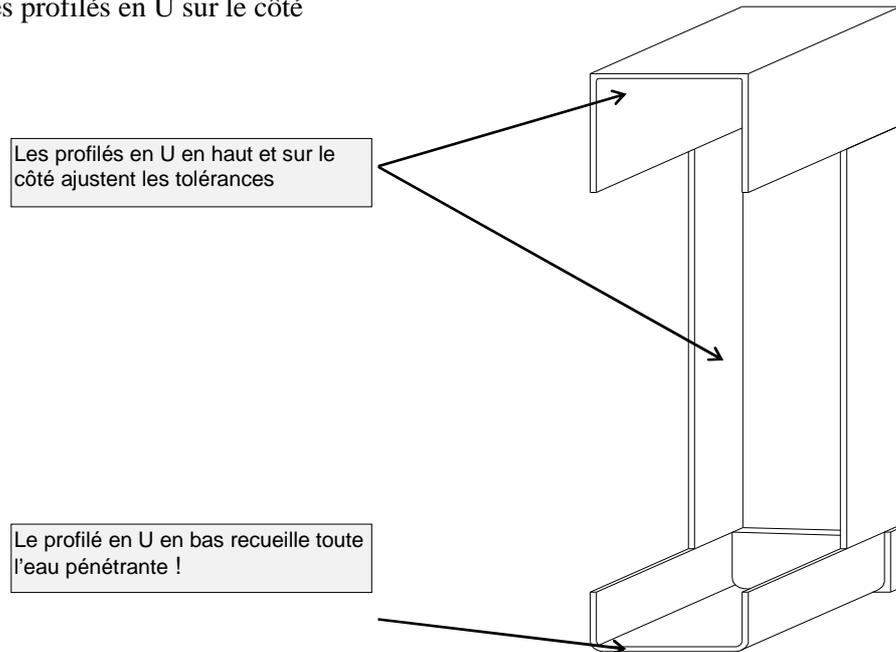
Vue Raccordement des profilés de nivellement en U, horizontaux et verticaux
